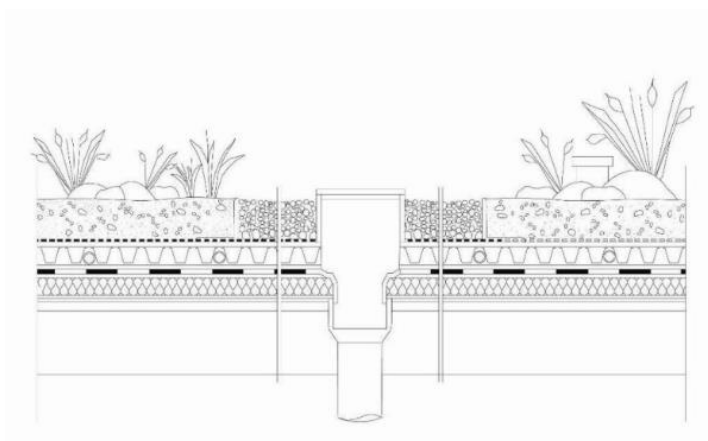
Sezione del tetto verde di tipo intensivo con dettaglio degli elementi secondari
